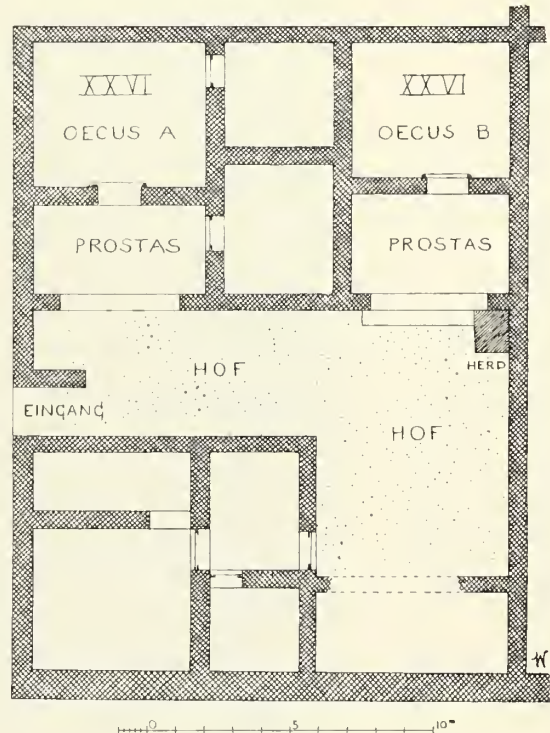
Grundriss des Hauses Nr. XXVI.
